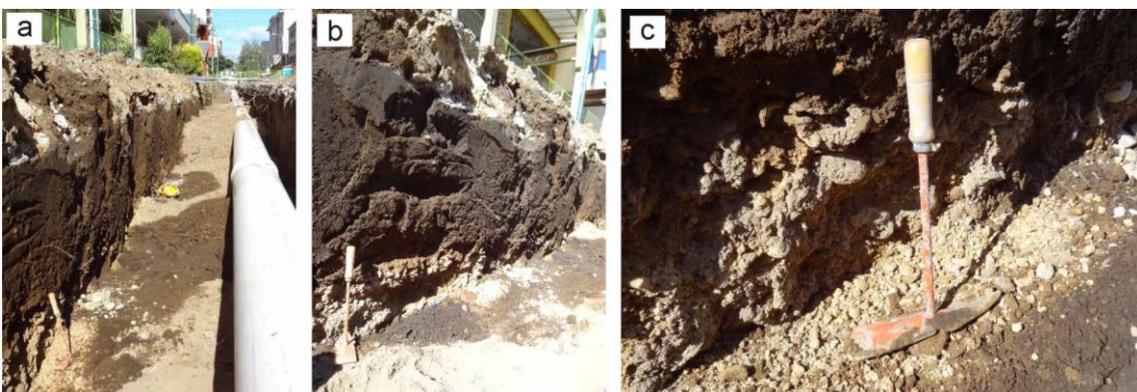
Trinchera Mitre 300-400. a) la estratigrafía completa de la trinchera sur; b) y c) Detalle de la estratigrafía perfil sur.
